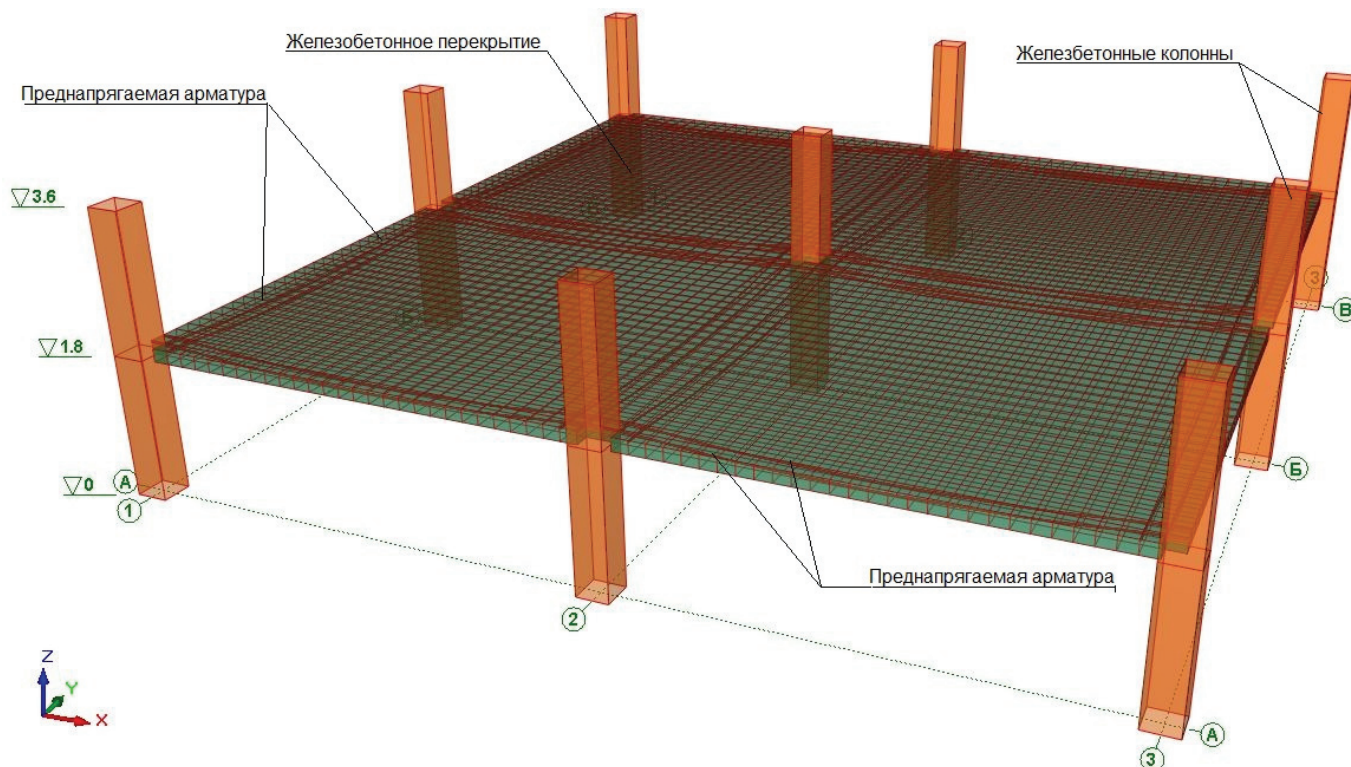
Фрагмент безригельного преднапряженного каркаса с плоским перекрытием
